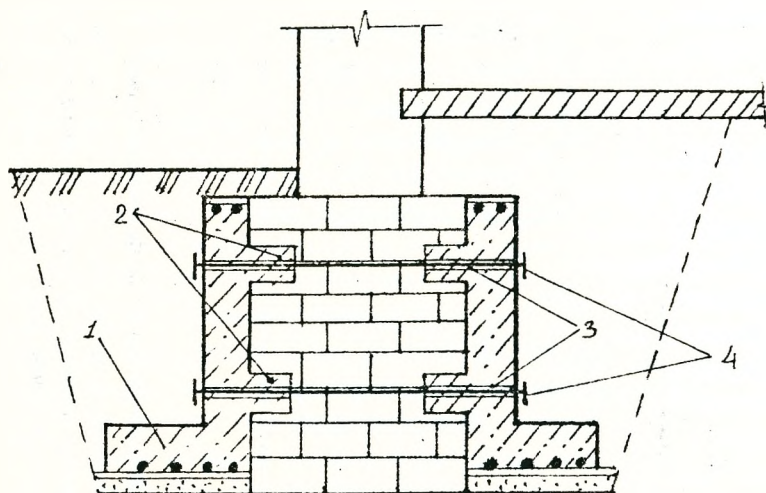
б. Увеличение опорной площади кирпичного или бетонного фундамента.
